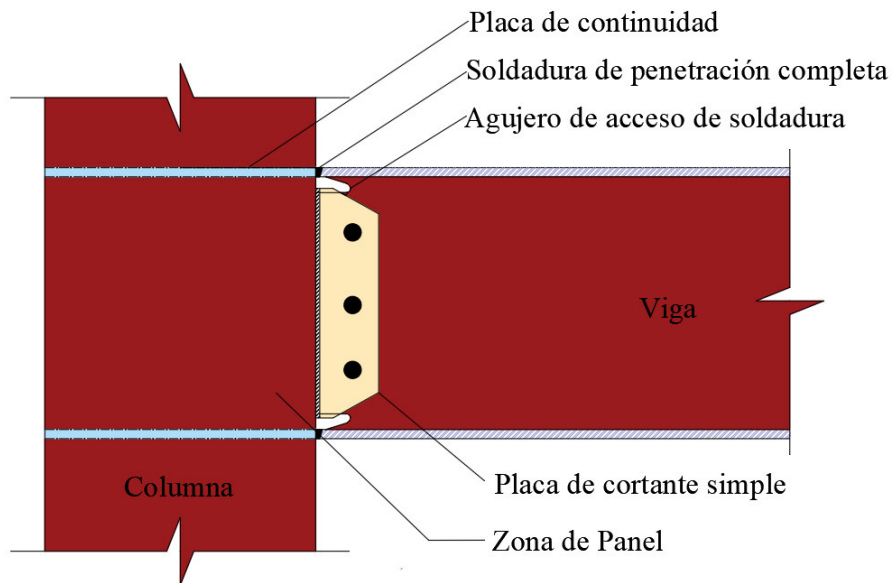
Conexión con ala soldada - alma soldada.
